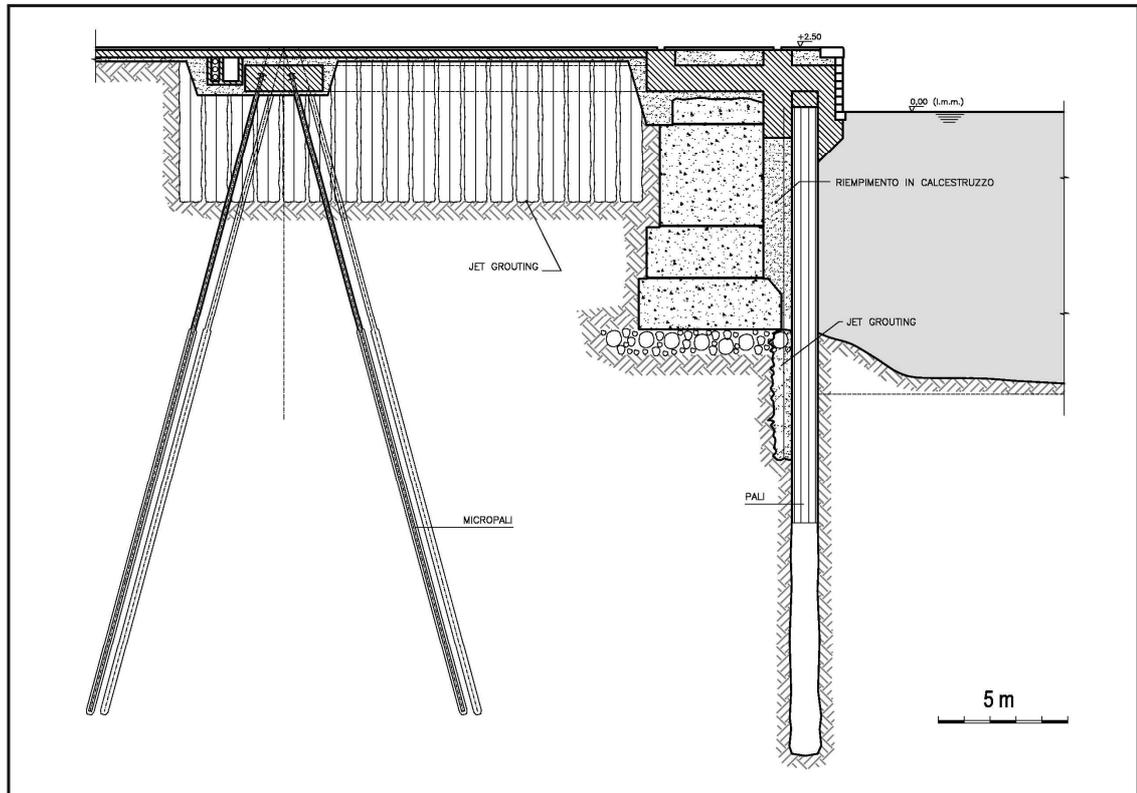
Porto di Messina – Sezione tipica banchina Vespri / Colapesce
